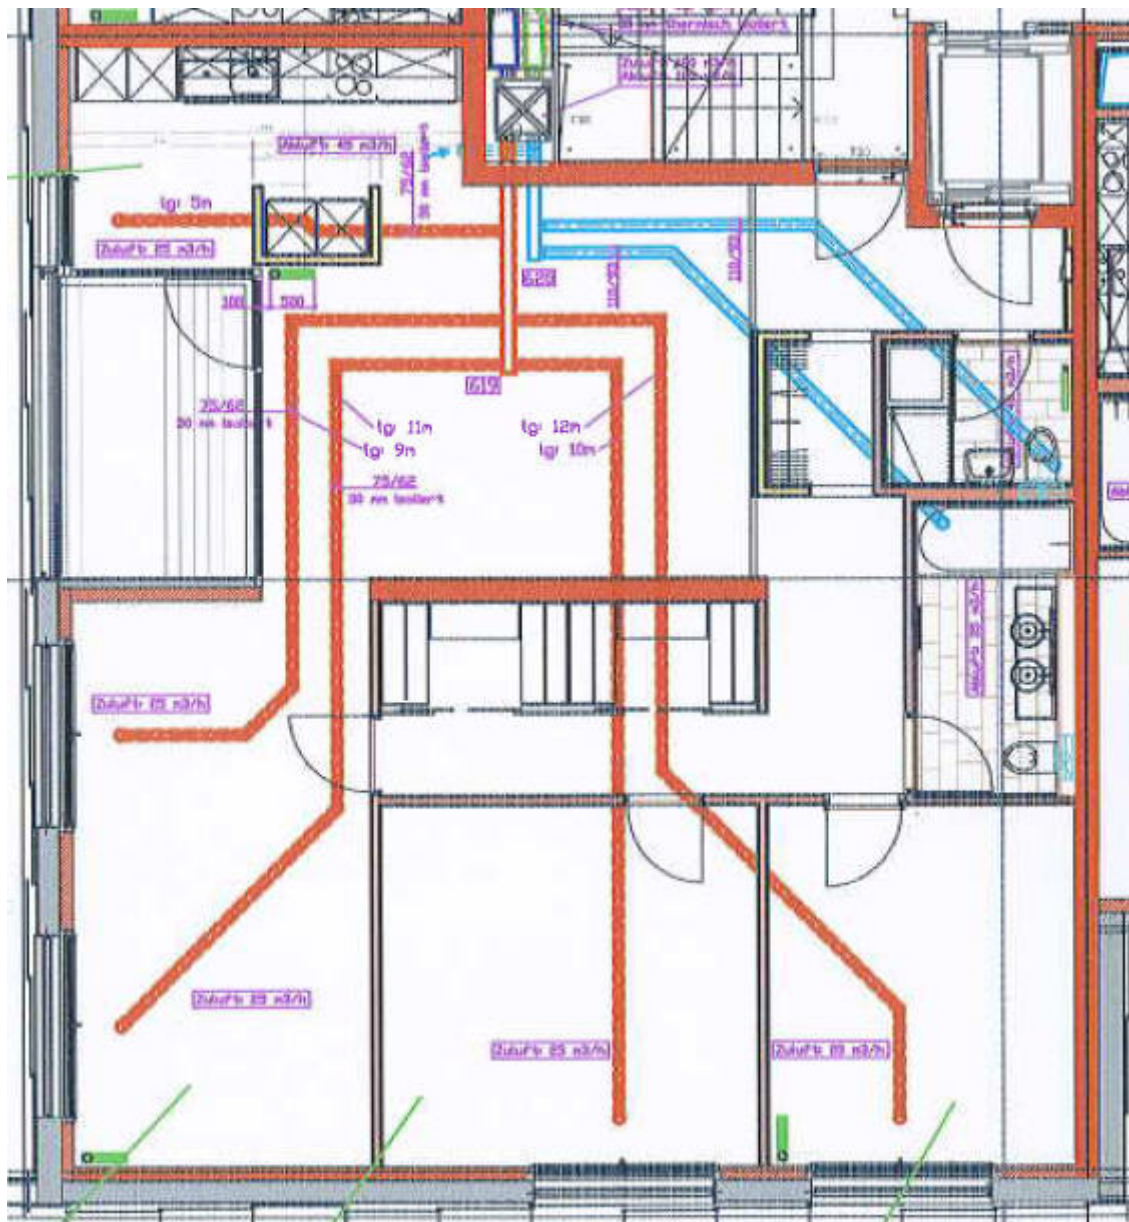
Grundriss Objekt1/Wohnung2
